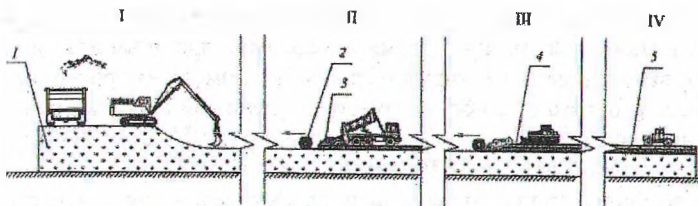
Технология строительства лесной дороги на болоте: I, II, III, IV – технологические этапы; 1 – слабый грунт; 2 – рулонный ГМ; 3 – грунт для возведения земляного полотна; 4 – разравнивание грунта; 5 – уплотнение грунта
